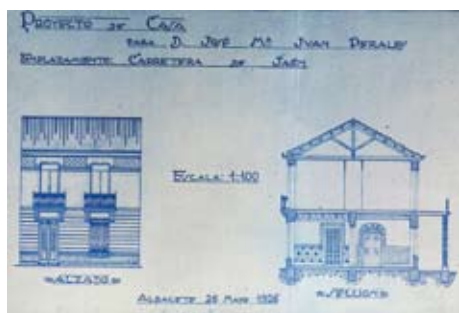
Alzado y sección Carretera de Jaén, 1926.
